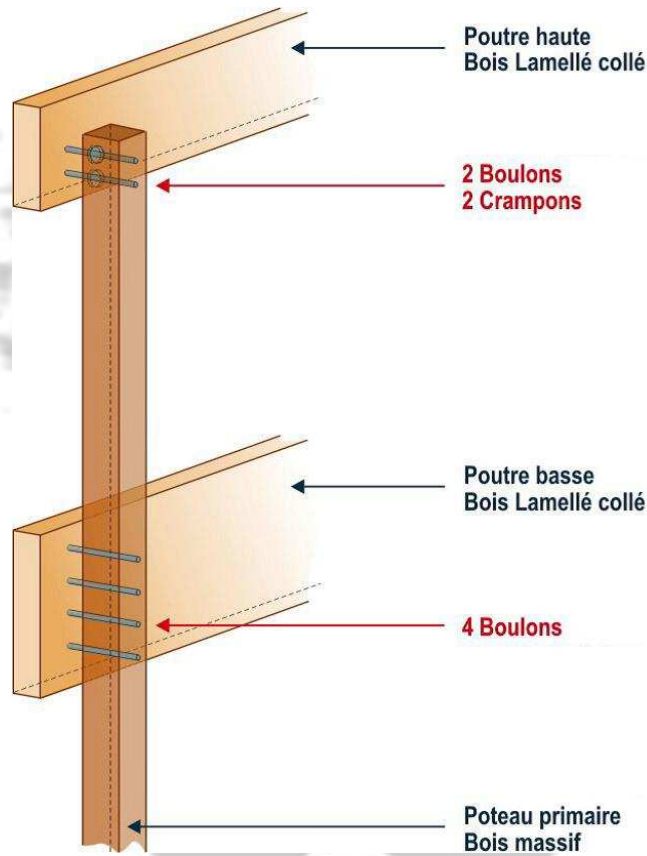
Liaison poteau poutre.(www.certu.fr)
